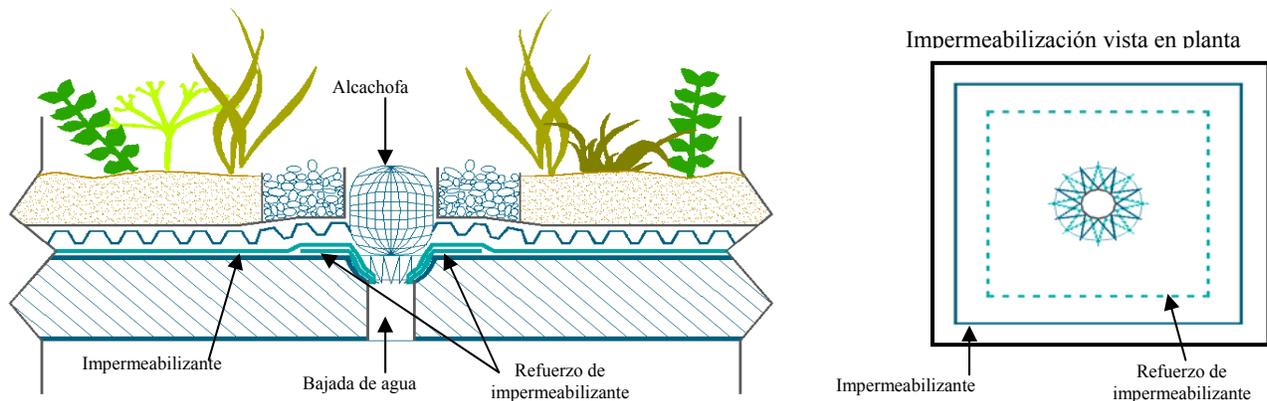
Impermeabilización y refuerzo en puntos de encuentro con bajadas de agua.
